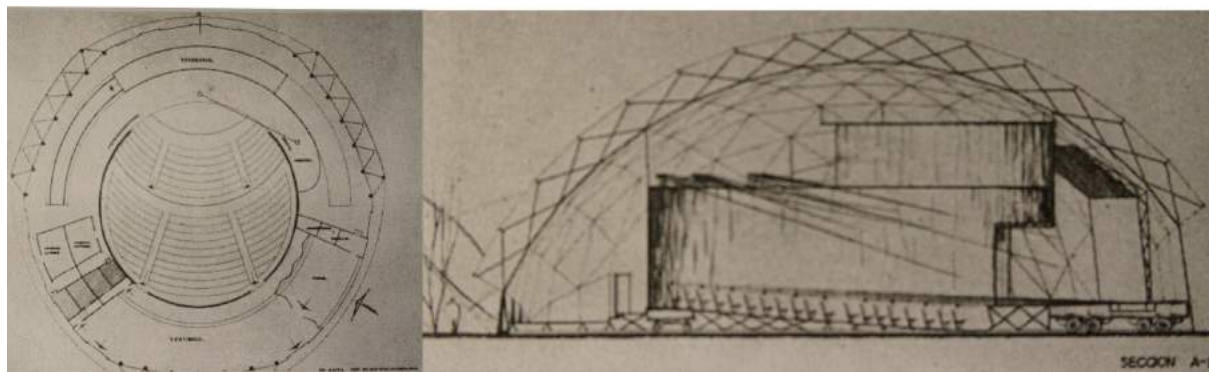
Planta y alzado del proyecto Teatro Ambulante
